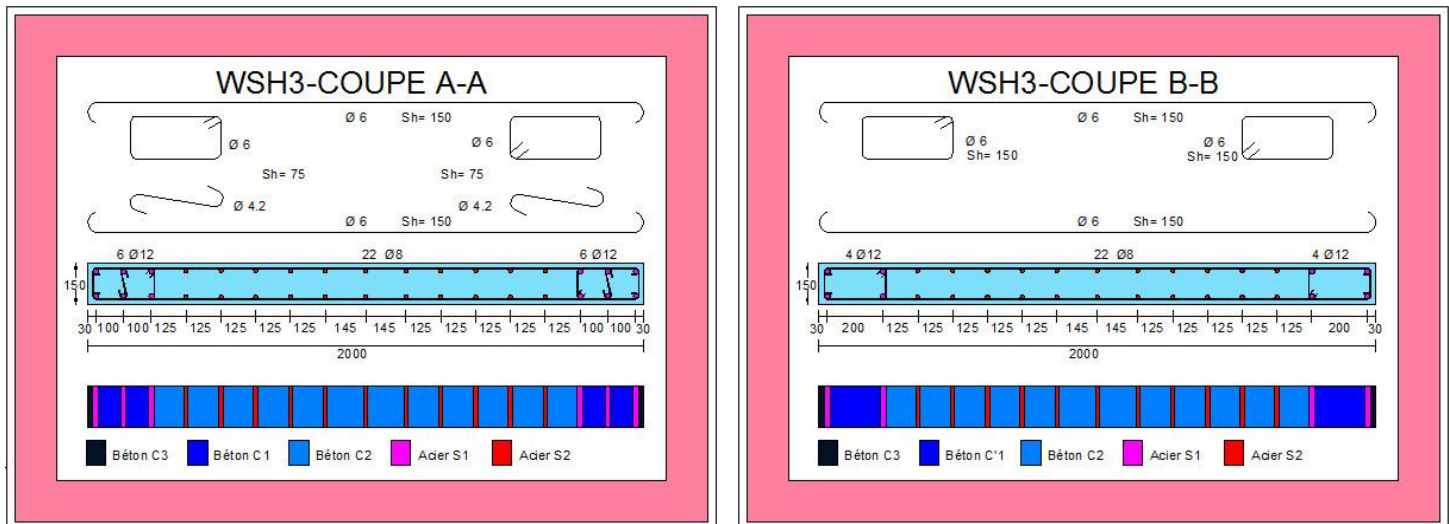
Ferrailage et modélisation multicouche de la section en béton armé, dimensions (mm) : WSH3, Coupe A-A et B-B
